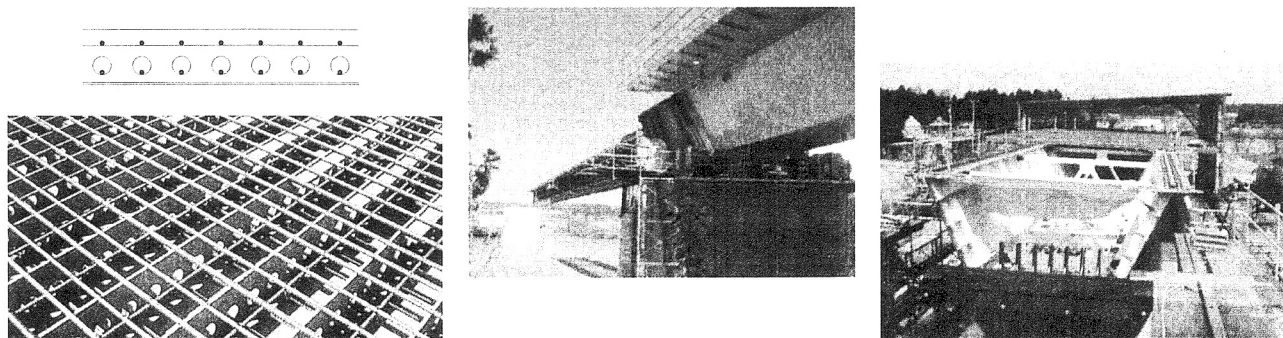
合成床版の施工事例 III：開断面箱桁橋への適用（送出し架設の例）
